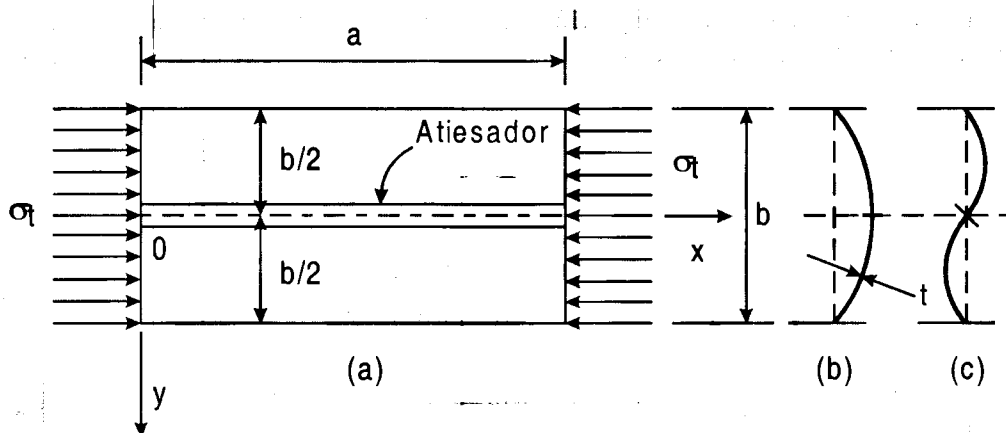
Placa libremente apoyada con un atiesador longitudinal central.
